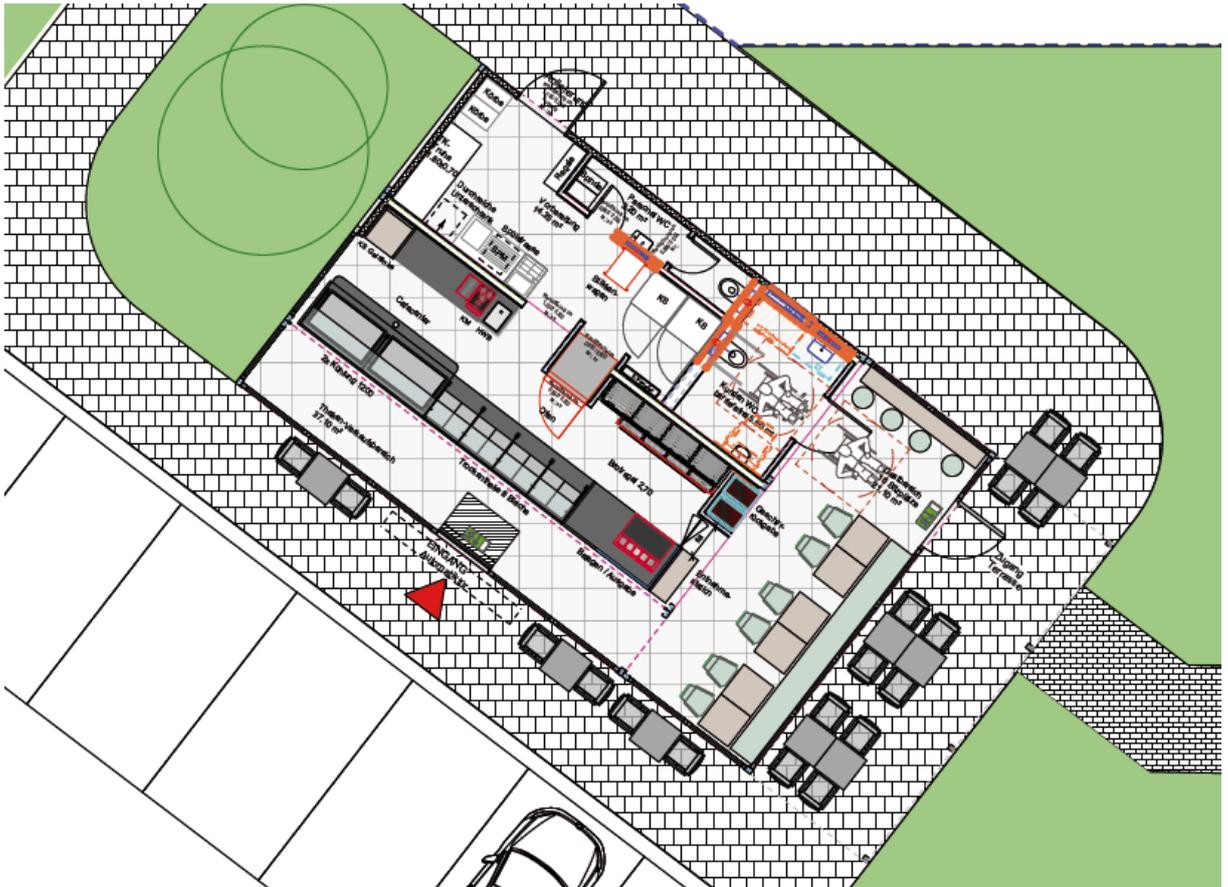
Grundriss der geplanten Bäckereifiliale, o.M. (Quelle: KEIL KONZEPTE Speyer, 25.09.2024)
